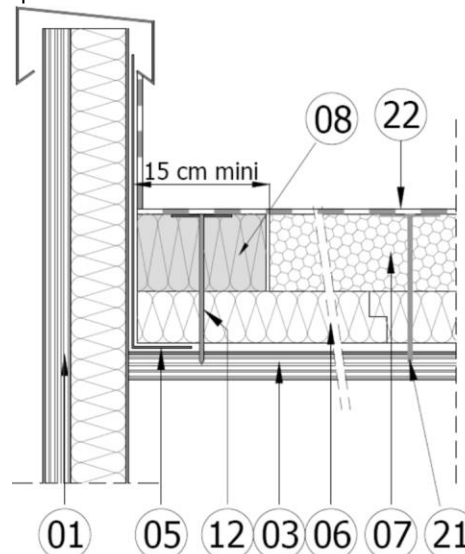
Exemple de calfeutrement horizontal contre un mur
